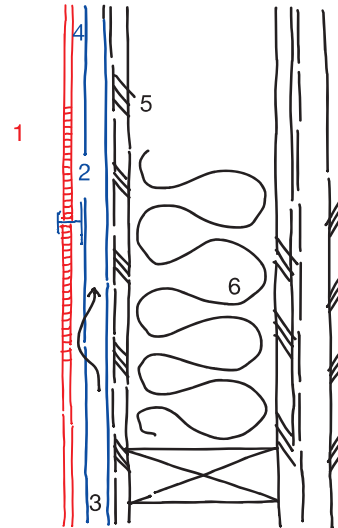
Regelquerschnitt einer möglichen Fassadenkonstruktion in Massiv- und Leichtbauweise (Prinzipiskizze)
